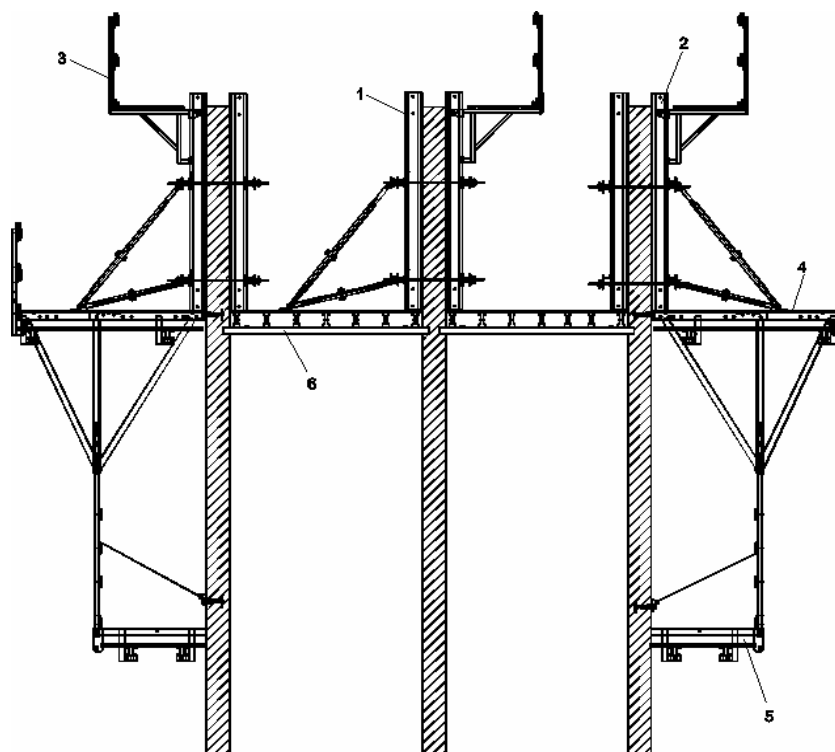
Схема устройства подъемно-переставной опалубки лифтового блока: 1 — внутренние блоки из щитов опалубки; 2 — наружная опалубочная панель; 3 — навесные подмости для бетонирования; 4 — рабочие подмости; 5 — нижние подмости; 6 — рабочая площадка шахты лифта с самофиксирующимися упорам [20]
